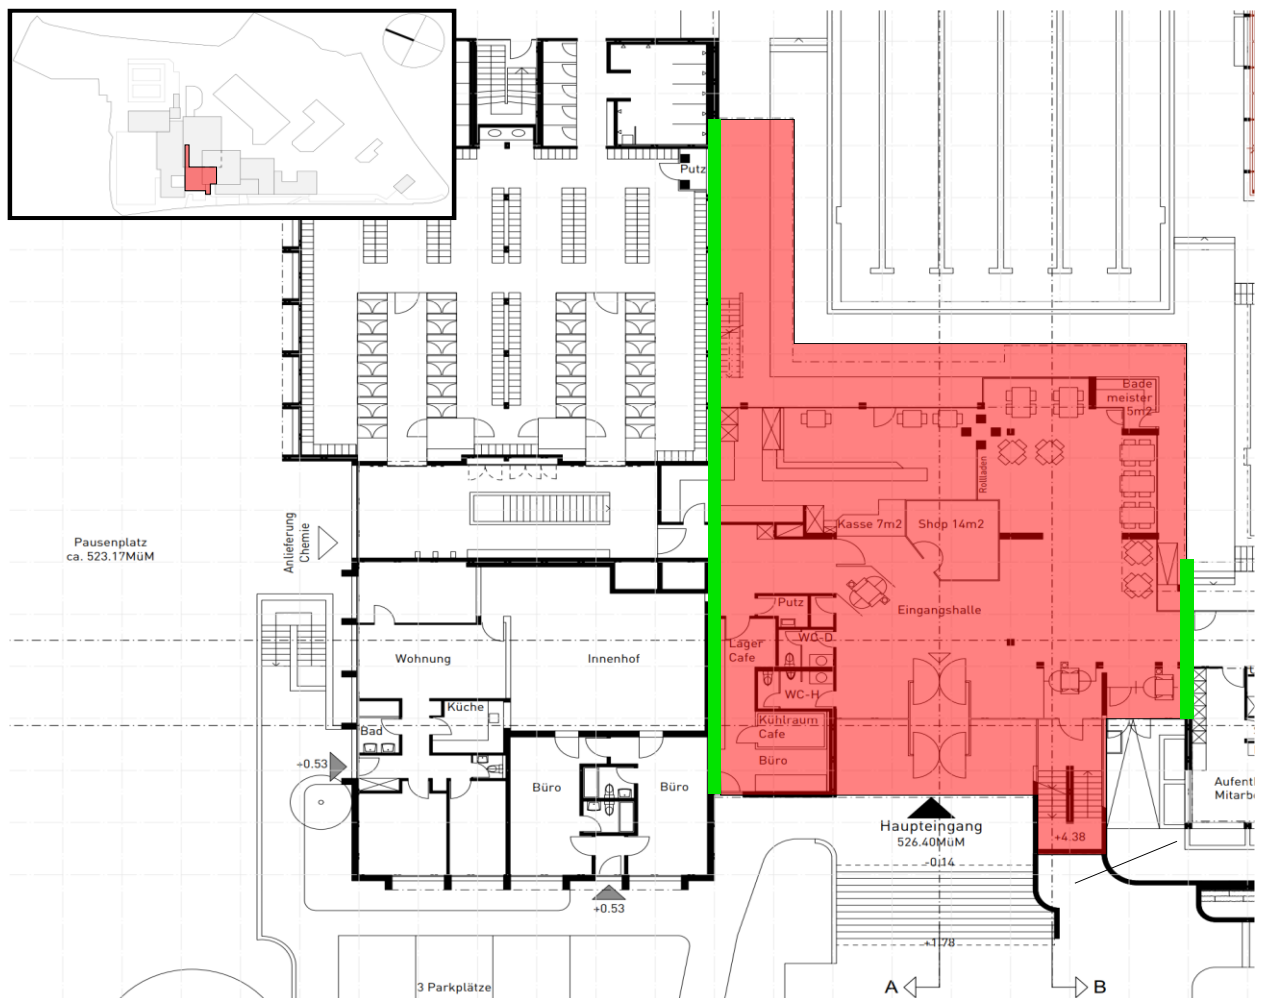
Untersucher Gebäudeteil Eingangshalle (rot markiert) mit Dilatationsfugen (grün markiert)
